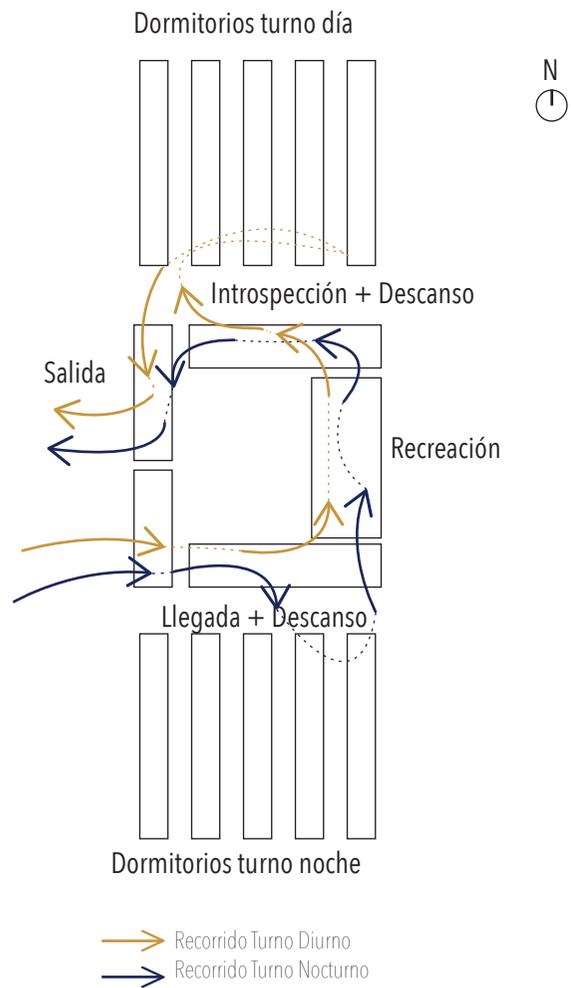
Planta esquemática de nueva disposición y recorrido en el campamento minero
